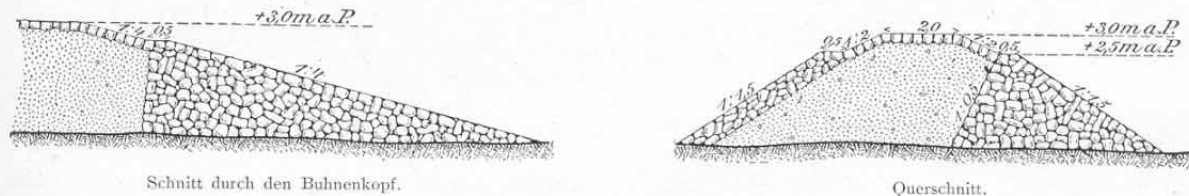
Construction der im Jahre 1887 und 1888 erbauten 16 Bühnen vor Hochhalen.
